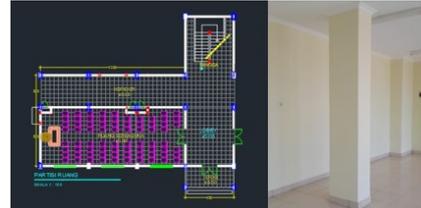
Denah Lantai 1 Rusunawa Gedanganak
